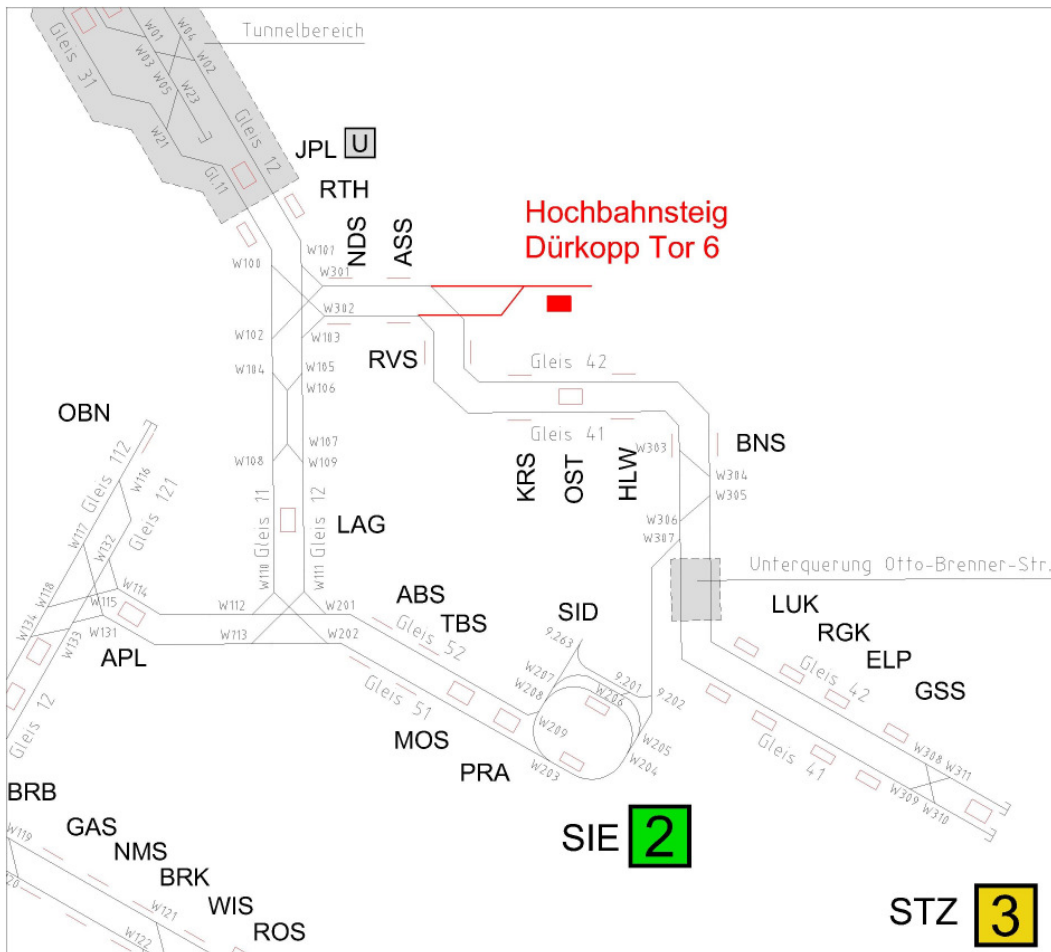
Schema Liniennetz mit Ergänzung Vorzugsvariante (Marktstraße ist hier als Ravensberger Straße dargestellt)
